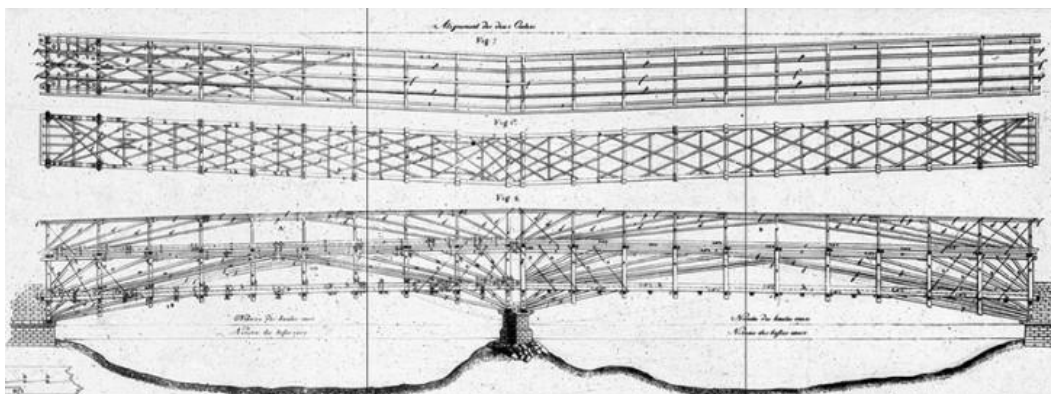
Desenhos da Ponte Rhinebridge (Tectónica, 2017).
